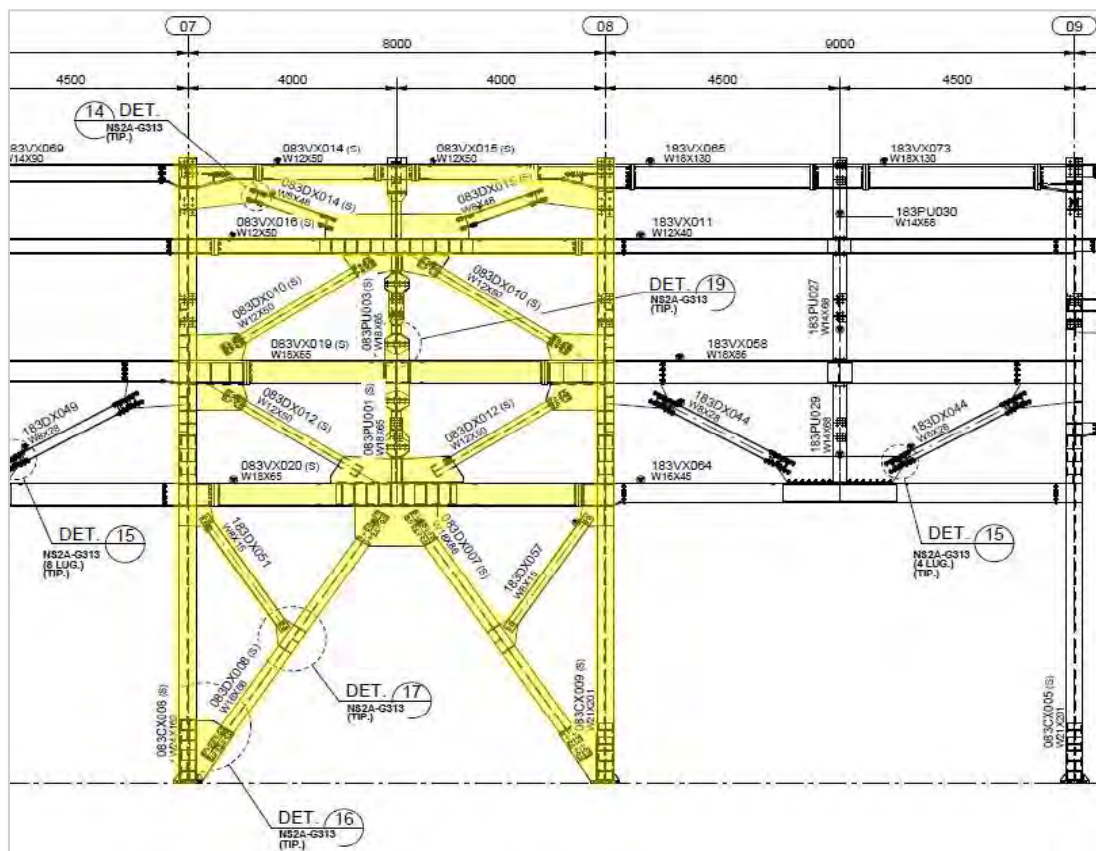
Vista de alzado de un *rack* – alzado compuesto resaltado
